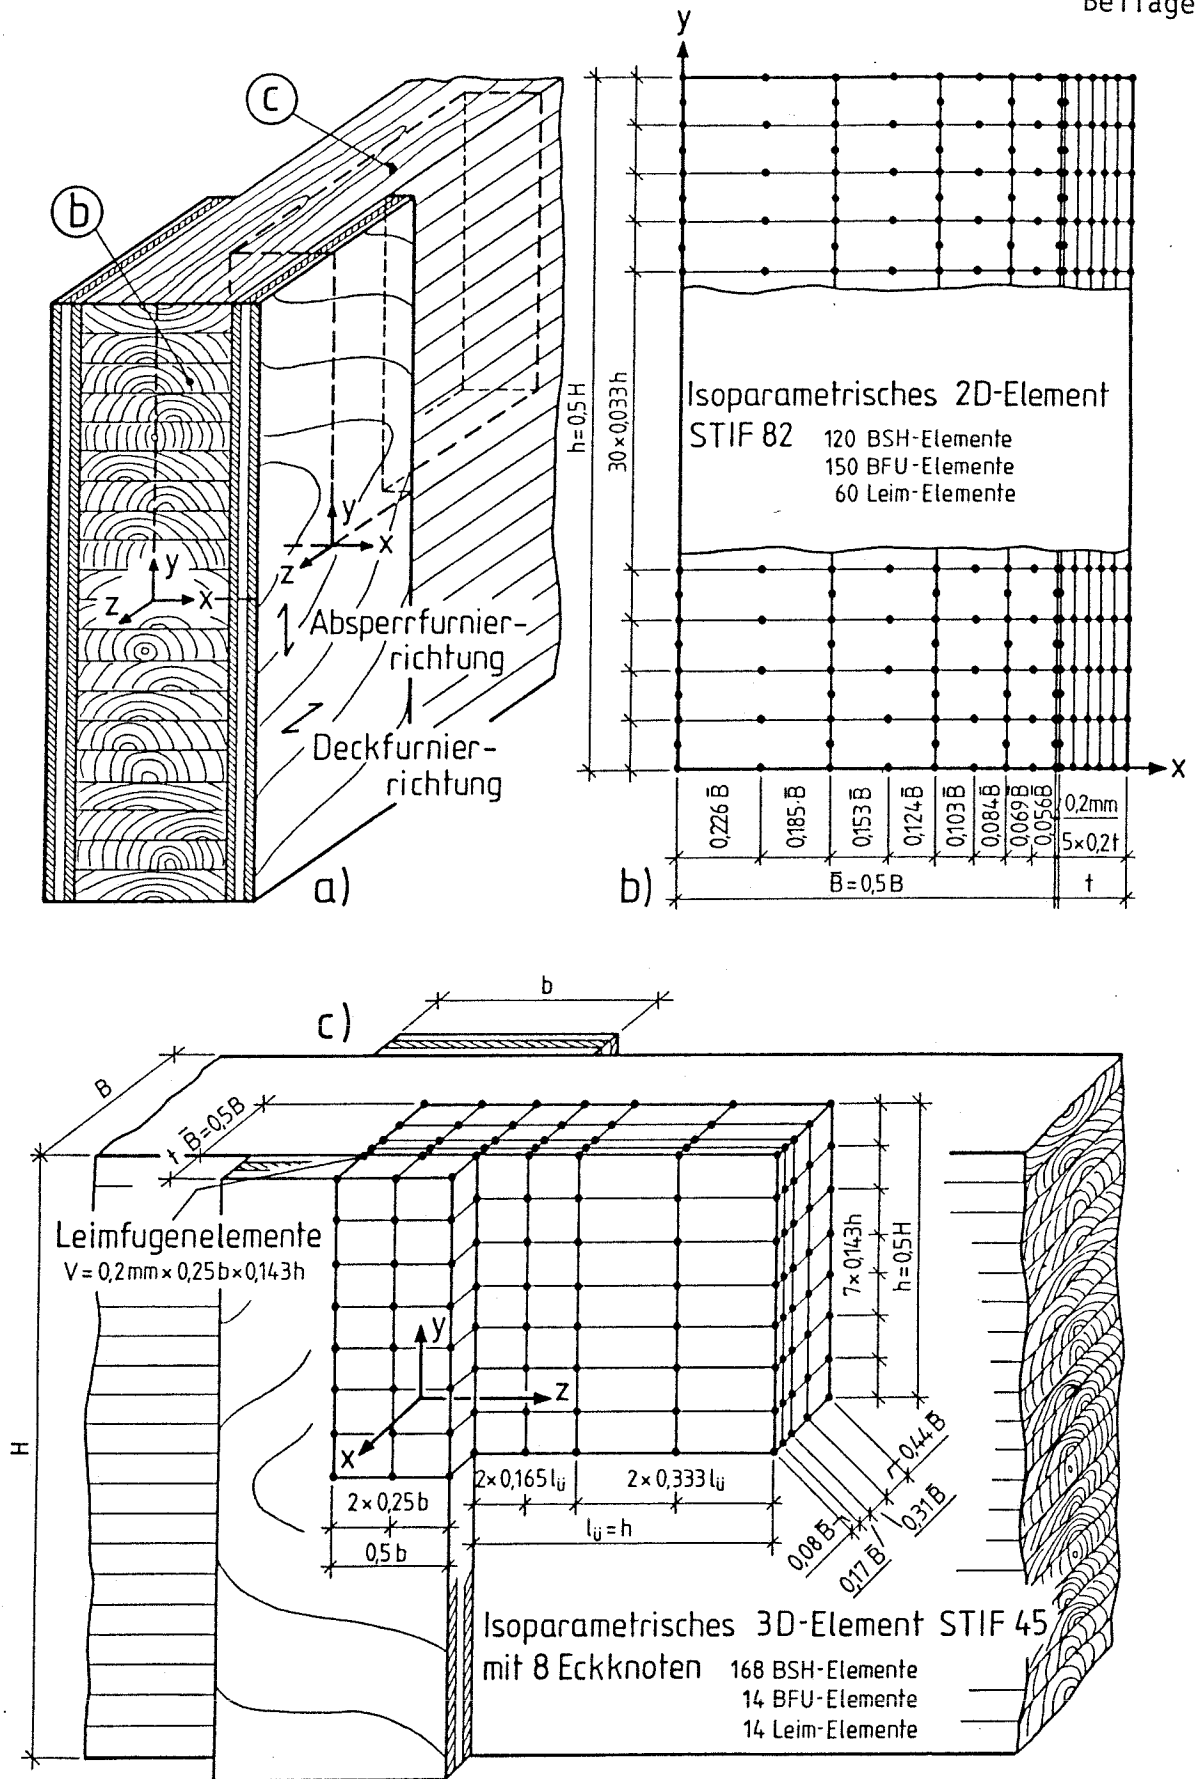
c: Brettschichtholz(BSH-)Träger mit aufgeklebten Bau-Furniersperrholz(BFU-)Beplankungen
